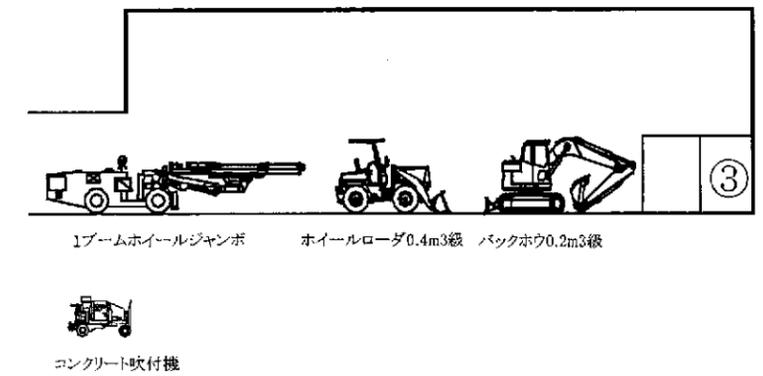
主立坑側 8.0m×6.5m坑道施工概要図
